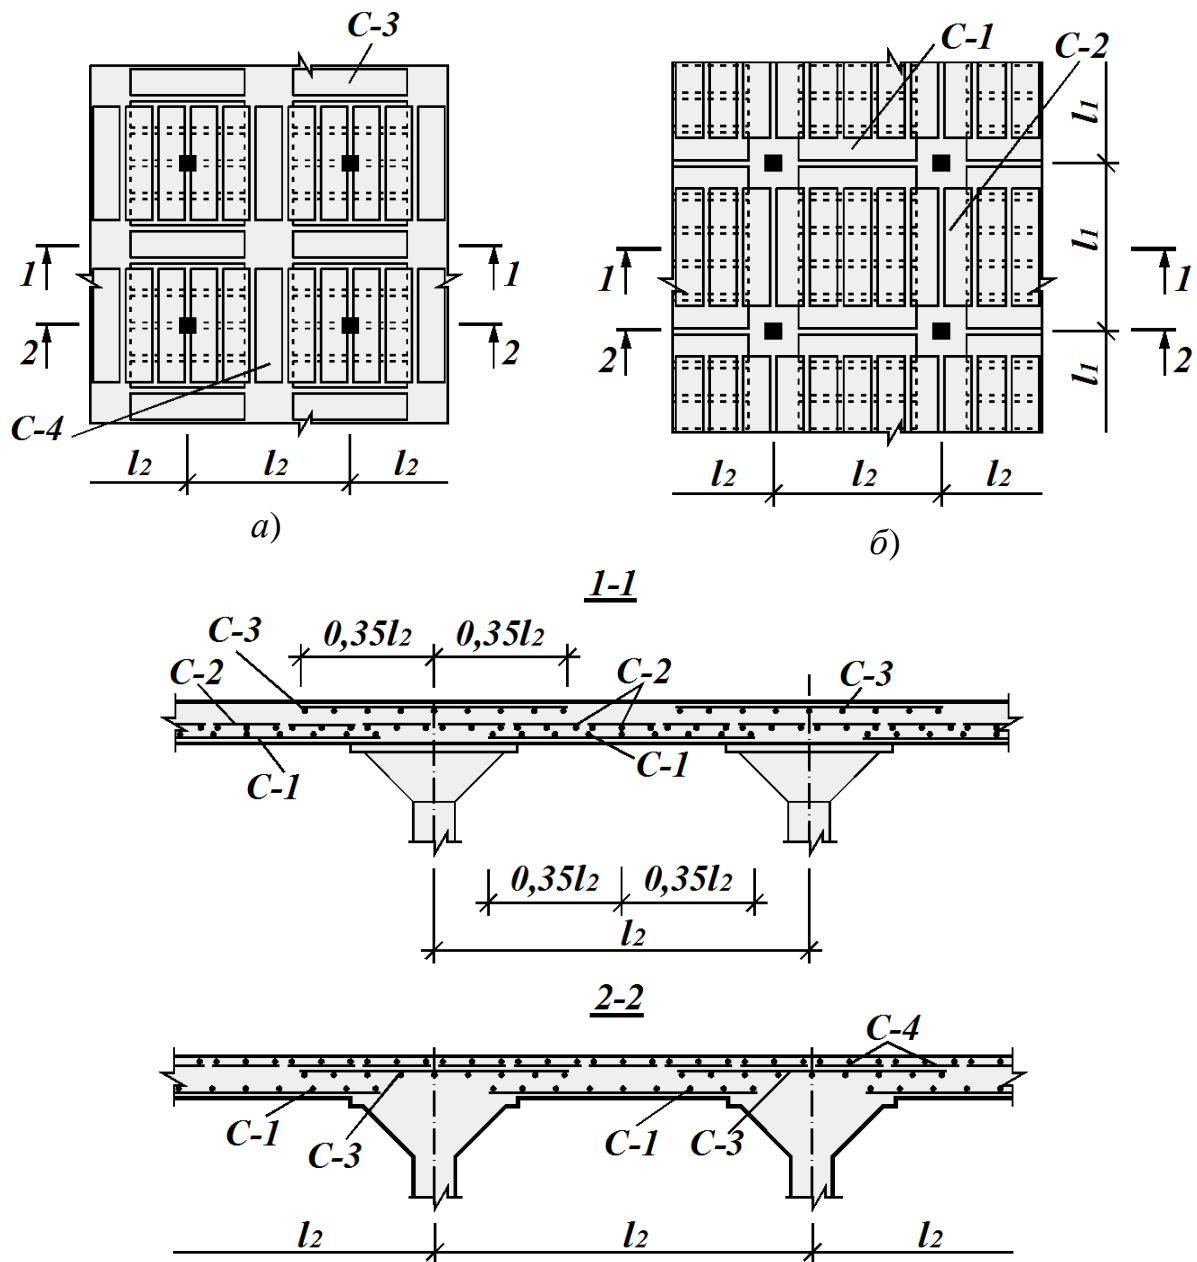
Схеми армування плити монолітного безбалкового перекриття вузькими сітками в плані:
